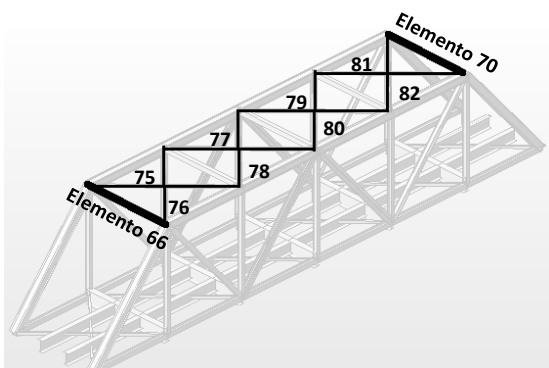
Elementos que requieren reforzamiento. Puente La Honda
